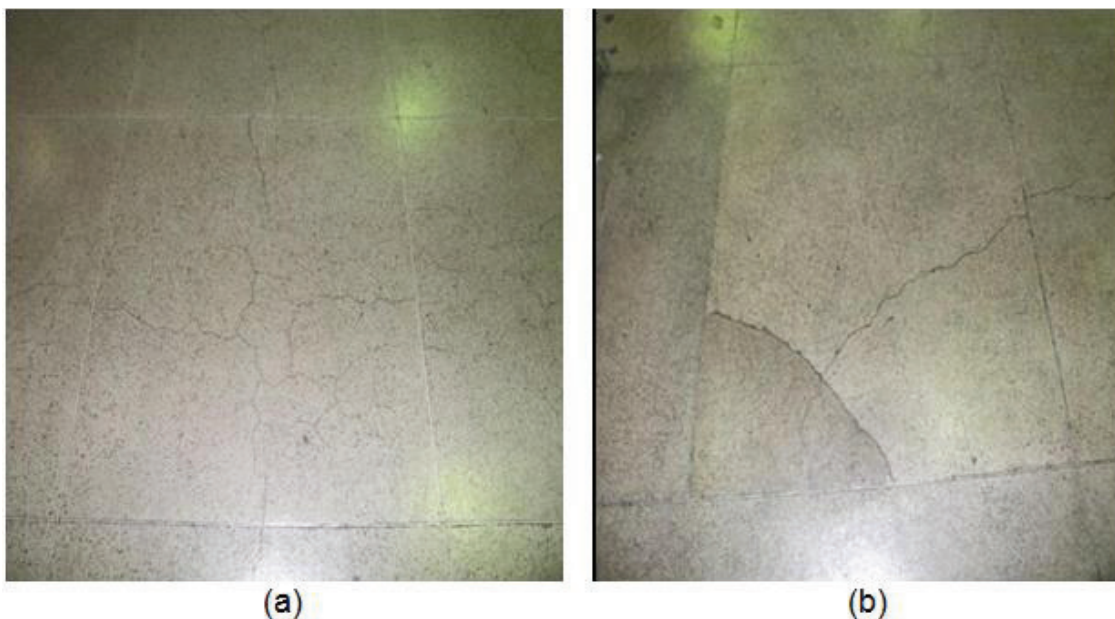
Granilite fissurado - Terminal Rodoviário. (a) fissuras por retração plástica; (b) fissuras por movimentação térmica.
